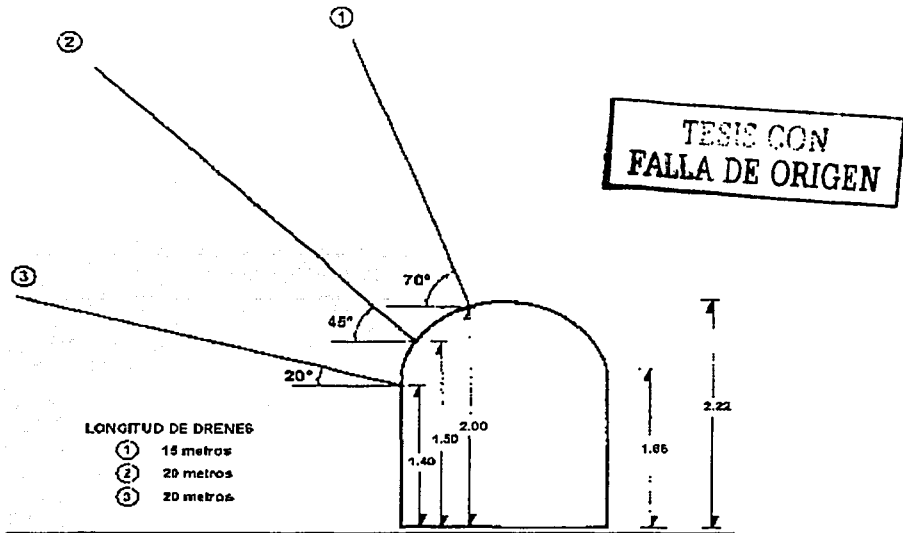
Barrenos de drenaje en galería de drenaje (1989).
